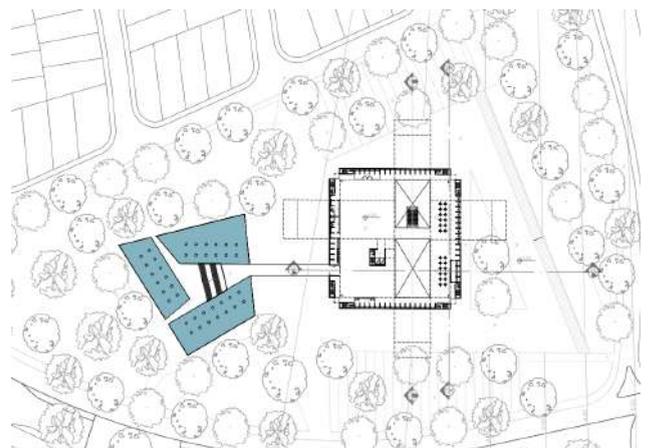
Planta do Pavimento Térreo do Museu. Realizado em software de Desenho AutoCAD
